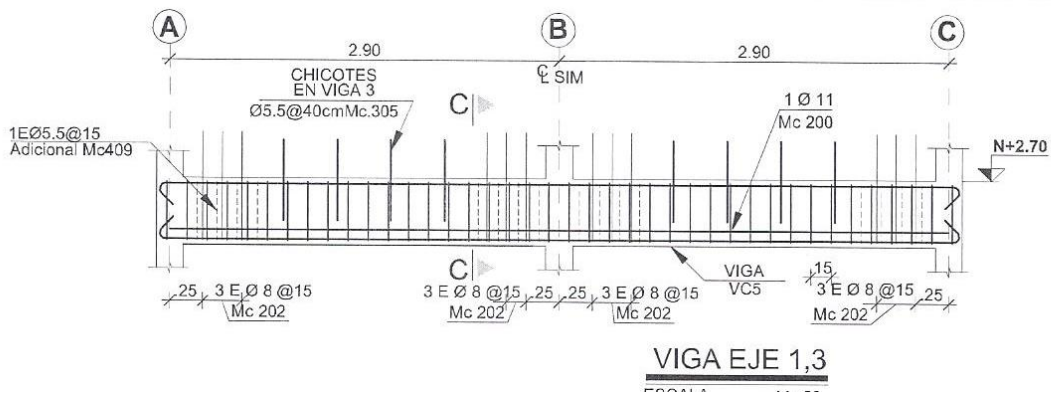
Detalle de la disposición de la viga en los Ejes 1 y 3
